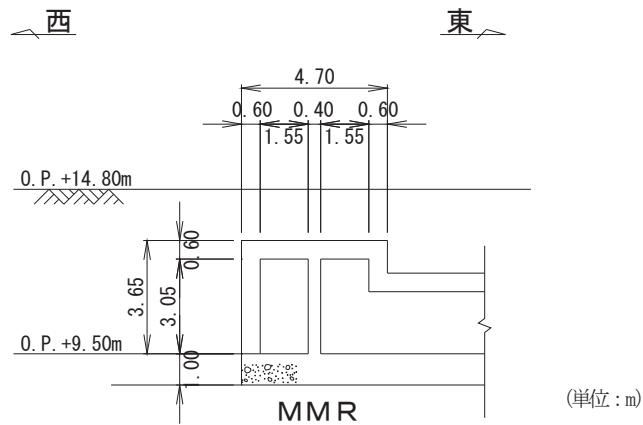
軽油タンク連絡ダクト断面図（接続部, B-B）
